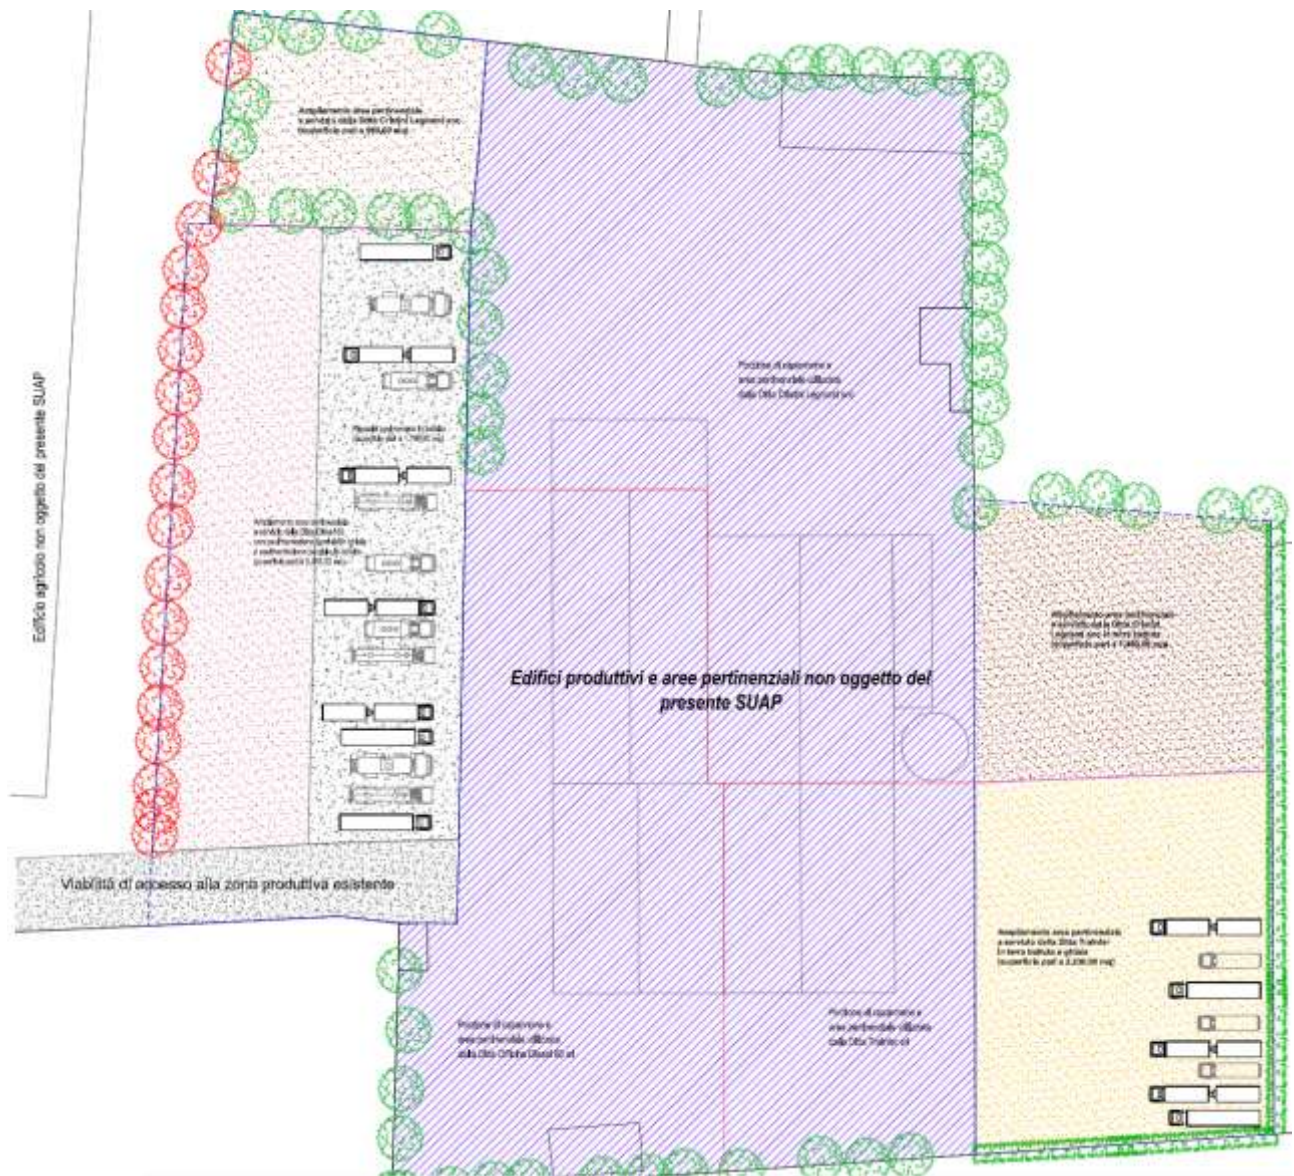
Planimetria generale dell'insediamento produttivo: stato di progetto
